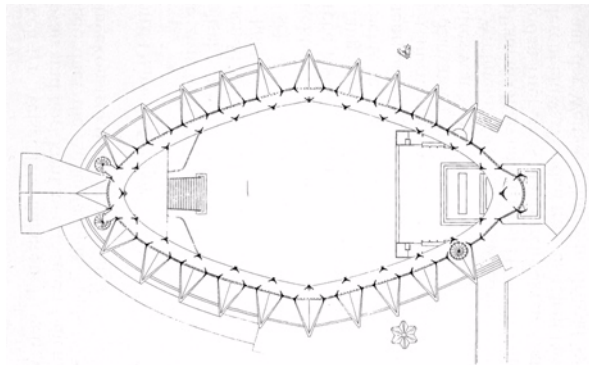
Kirche Notre Dame, Grundriss.
